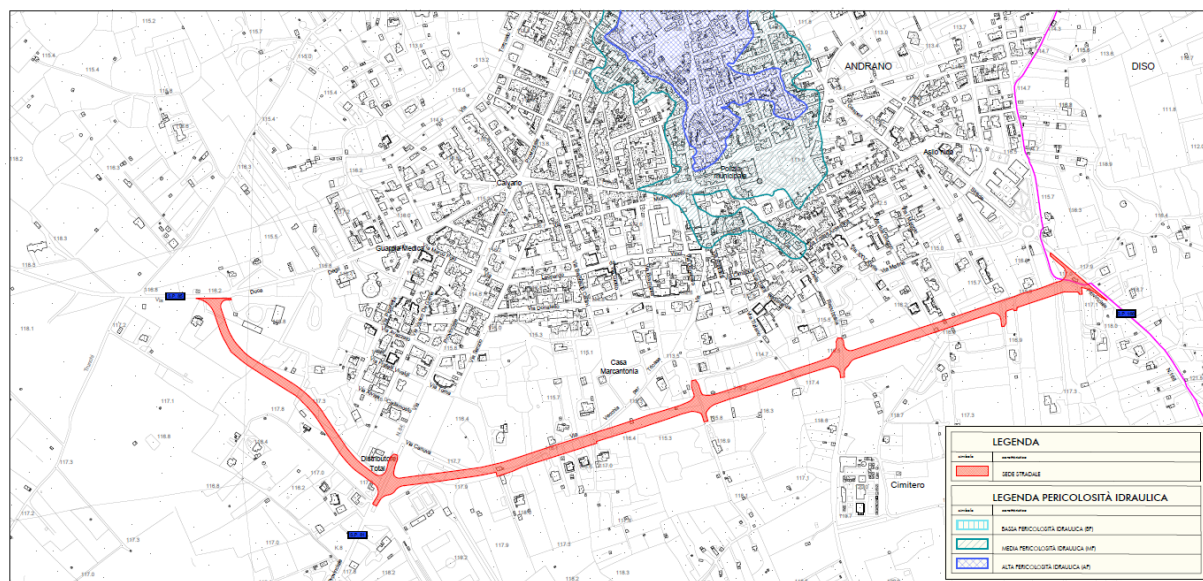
Planimetria generale dell'intervento di Andrano, in arancione è evidenziata la nuova viabilità
